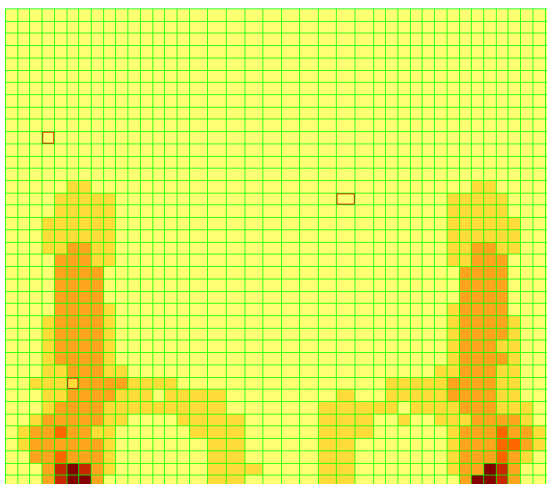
Армирования верхней зоны вдоль буквенных осей (см²)
